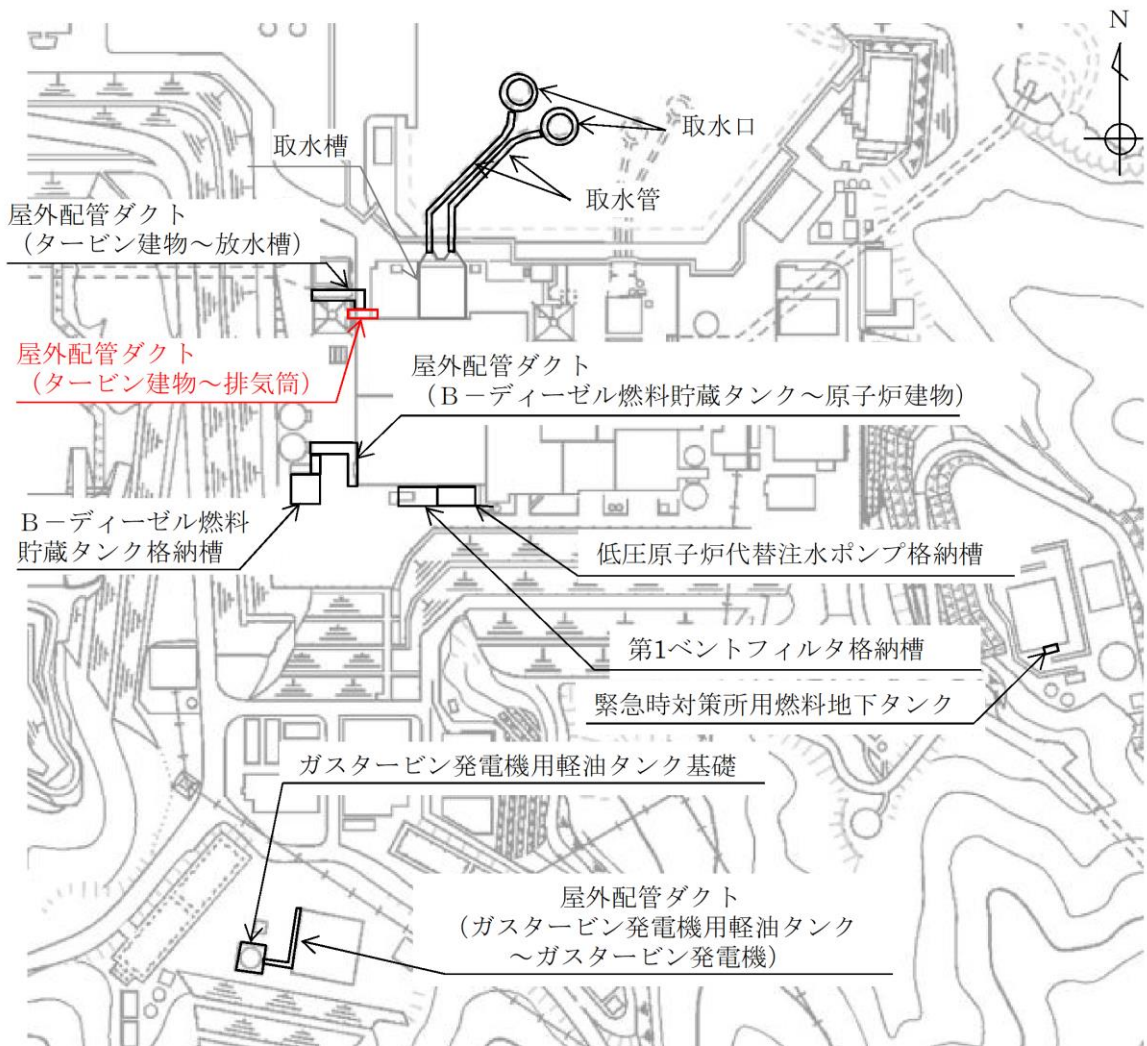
屋外配管ダクト（タービン建物～排気筒） 配置図
